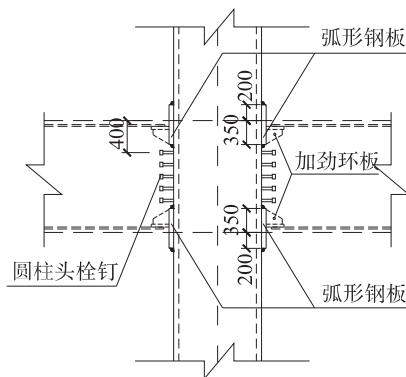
钢管混凝土支承柱的传力钢板连接构造示意图
